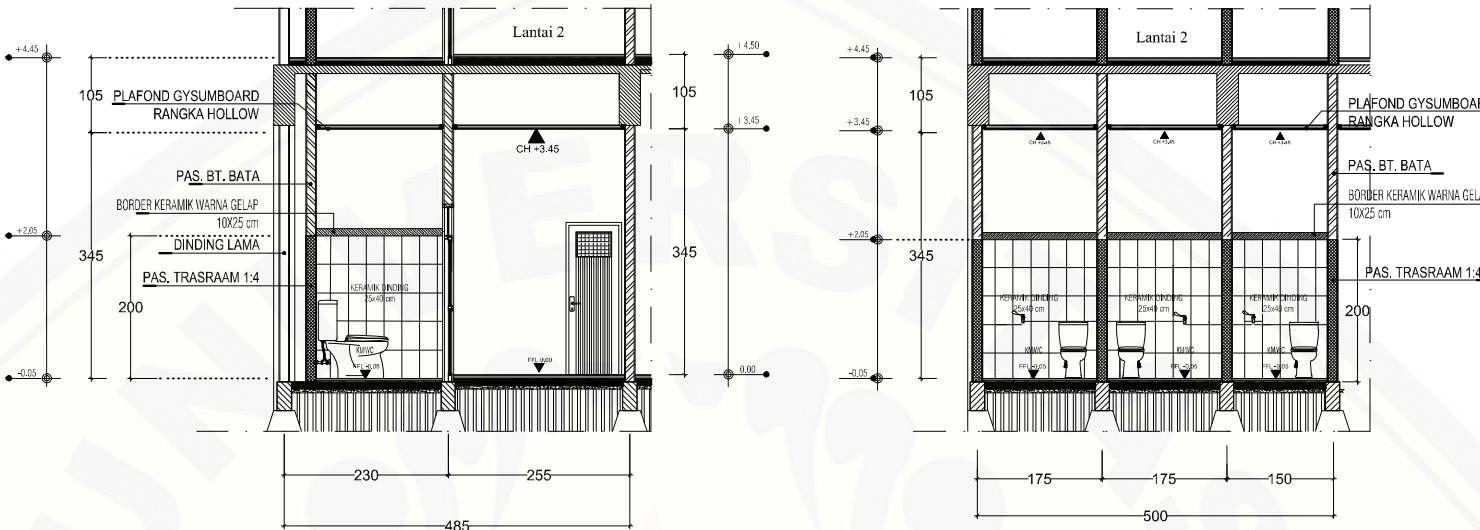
DETAIL PEMASANGAN KERAMIK DINING 1 : 20
